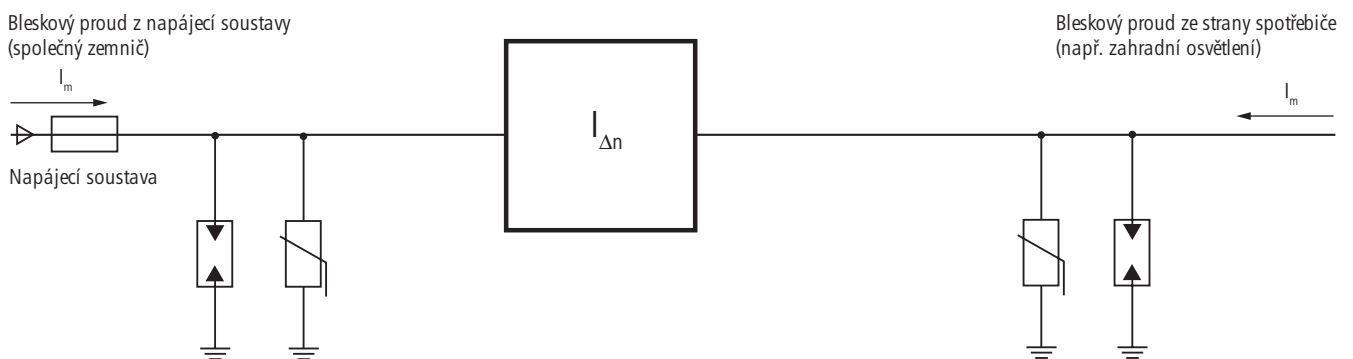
Chybné zapojení ovládacích obvodů před a za proudovým chráničem.
